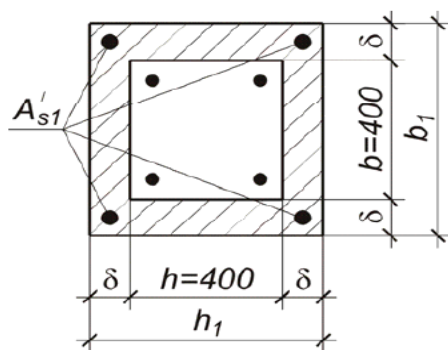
Расчетное сечение колонны, усиленной железобетонной обоймой
